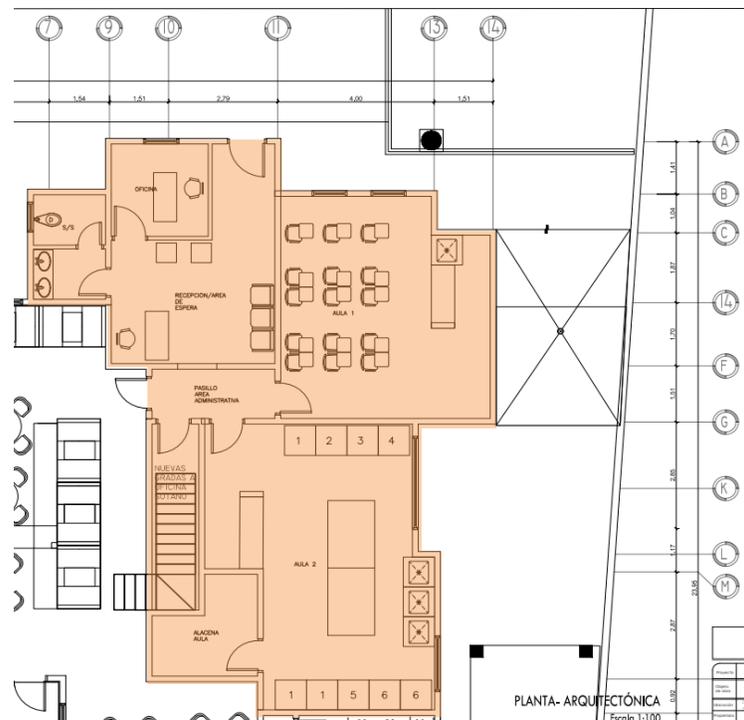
Planta Arquitectónica de Restaurante Kim Chon
